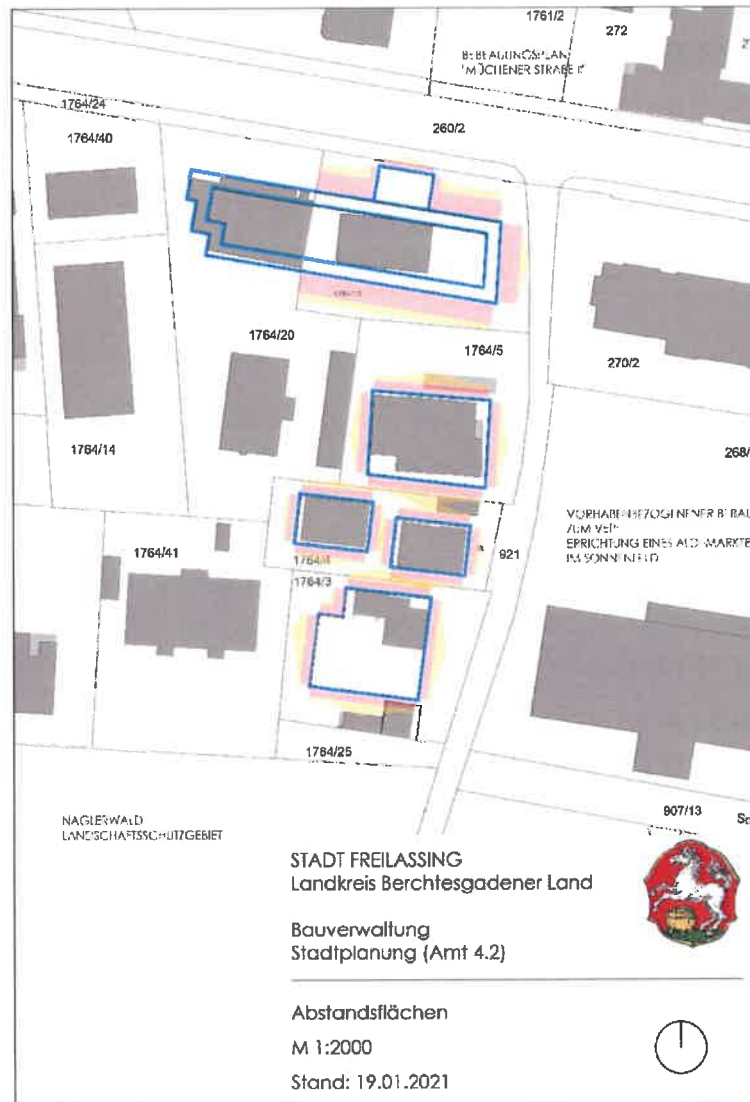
Darstellung der Abstandsflächen nach BayBO 2021 (Quelle: Stadt Freilassing)
